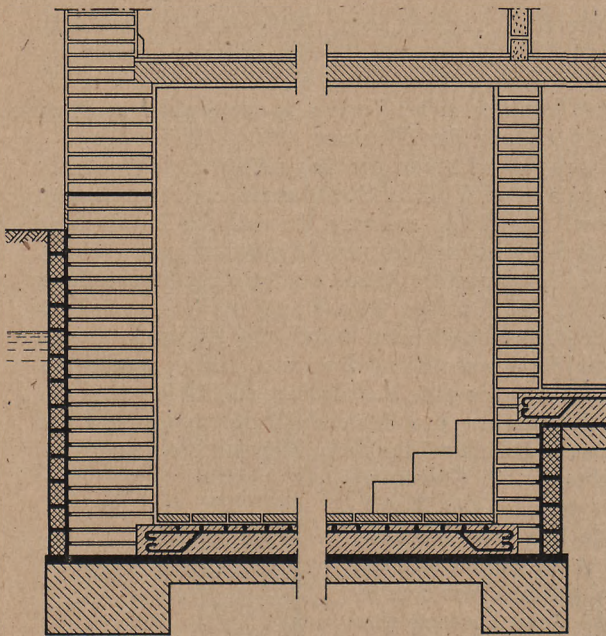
Absperrung des Kellergeschosses mit Gußasphalt bei Grundwasser
